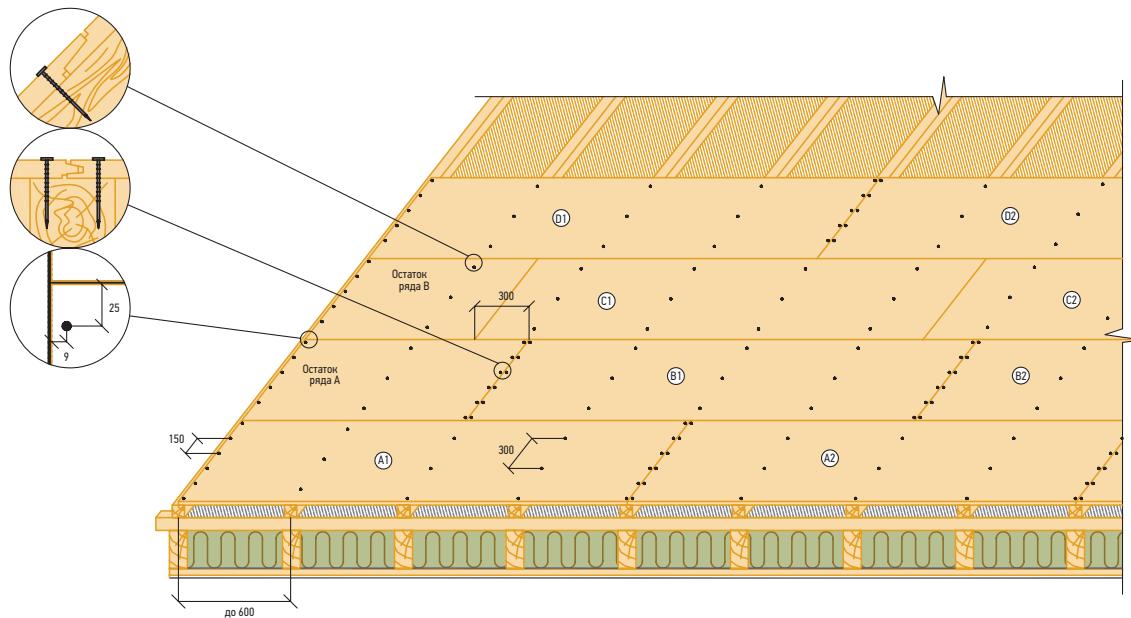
Монтаж сплошного основания из плиты Tegodeck
